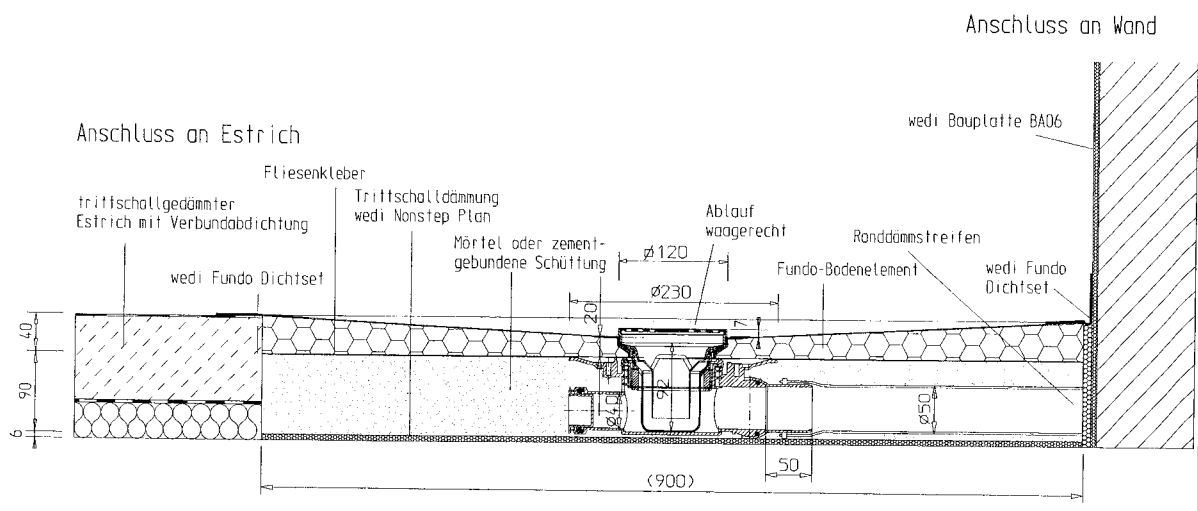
Wedi Fundo mit nonstep plan + Estrich, Ablauf waagrecht
